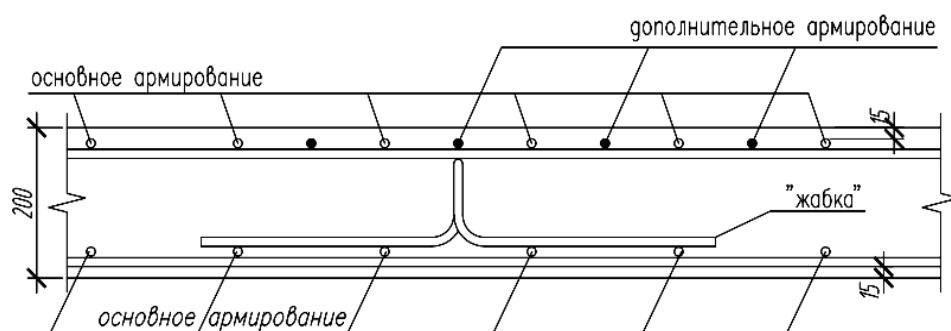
Характерное поперечное сечение монолитной безбалочной плиты перекрытия.
